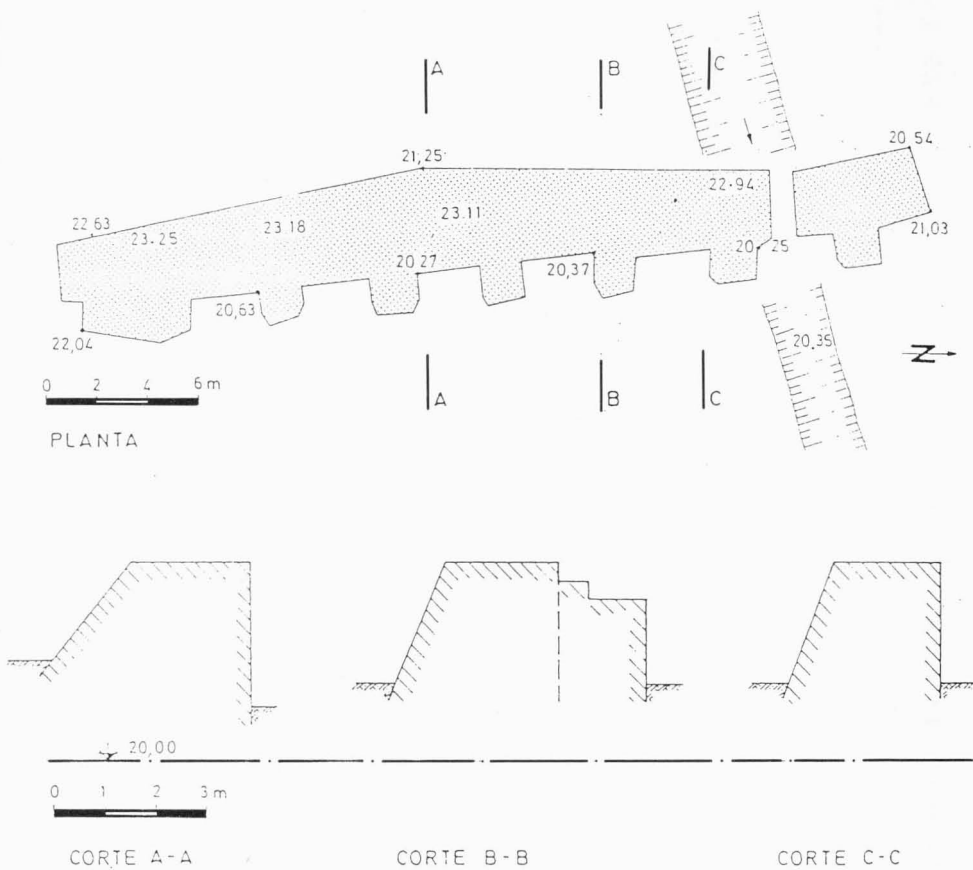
Barragem de Álamo (Alcoutim). Planta e cortes.
